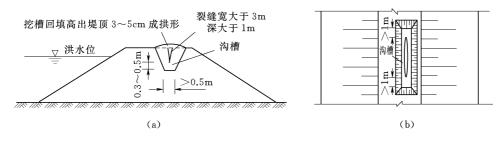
开挖回填处理裂缝示意图 (a) 剖面图; (b) 平面图
